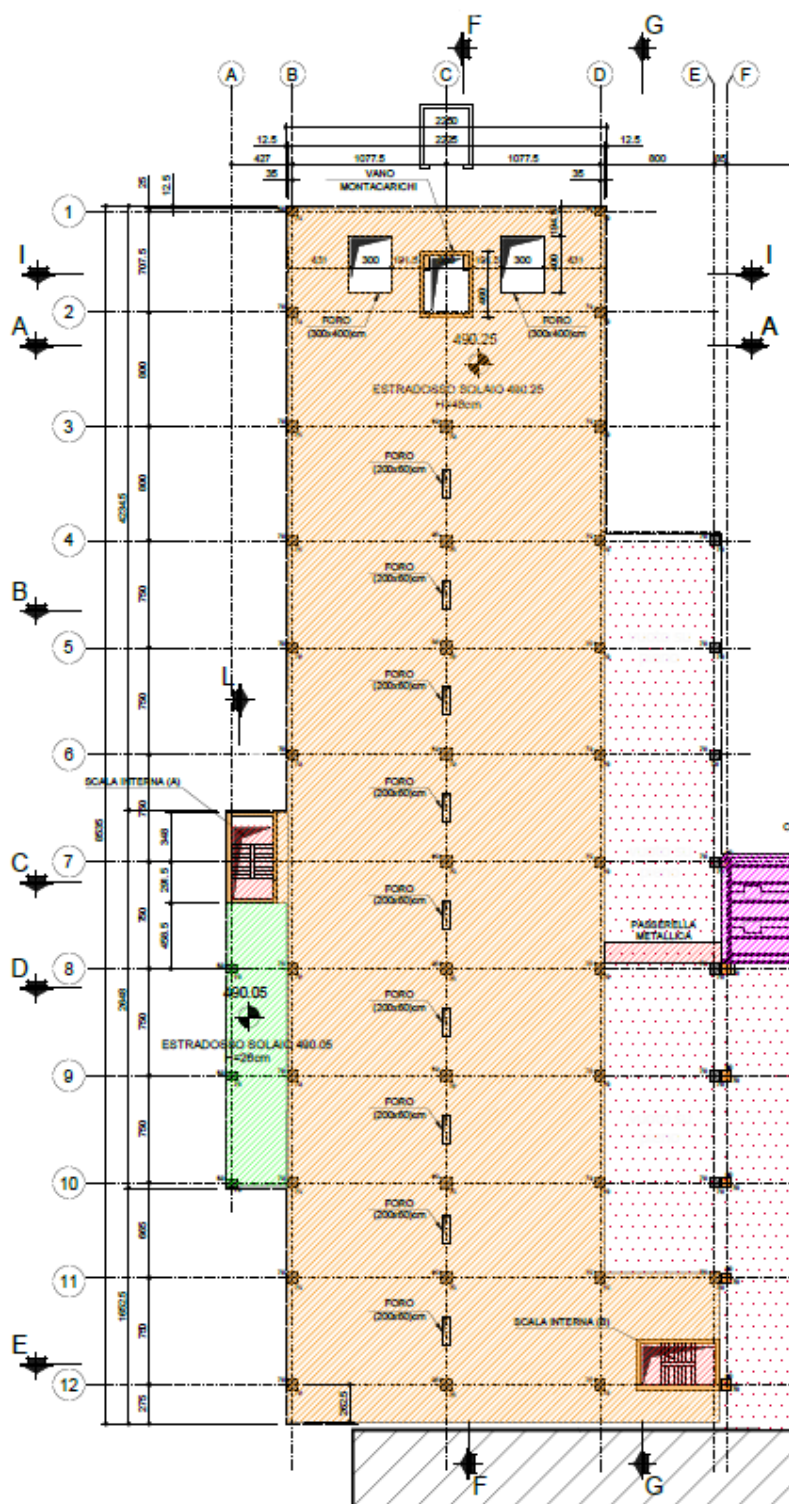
Planimetria piano P1 – Fabbricato ex. Piemonte
